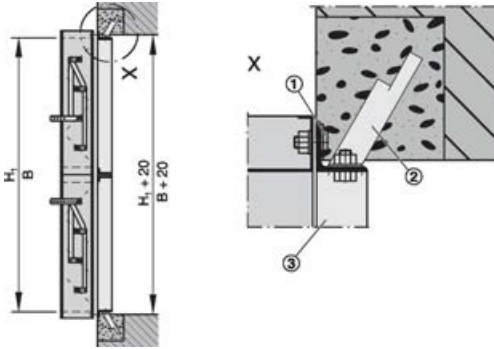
Installation murale avec contre-cadre (construction en acier/acier inox), hauteur subdivisée
